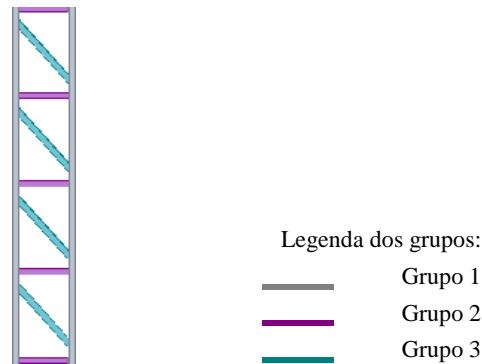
Discretização do pilar-treliça para a generalidade das estruturas modulares
